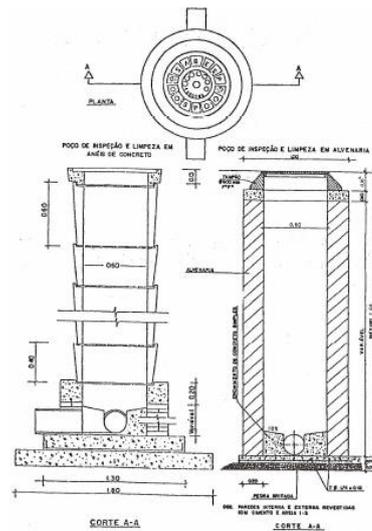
TIL em alvenaria e em aduelas pré-moldadas de concreto.
